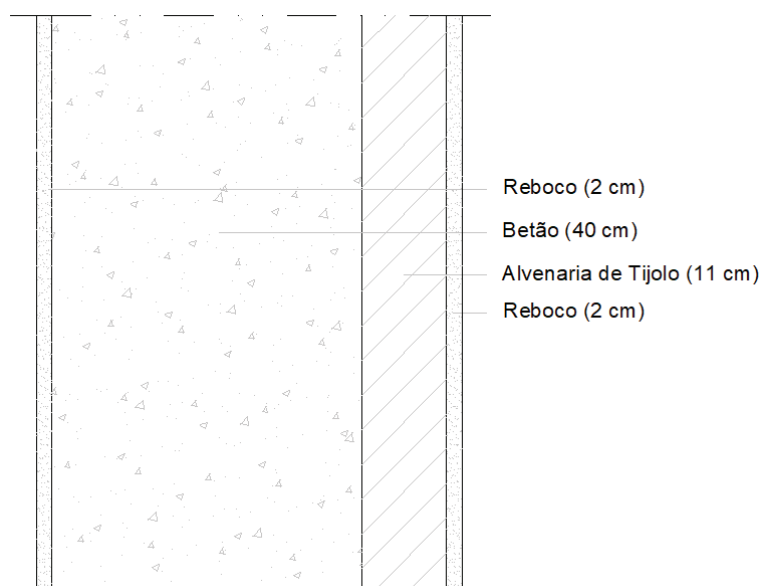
Pormenor construtivo da parede exterior tipo IV
